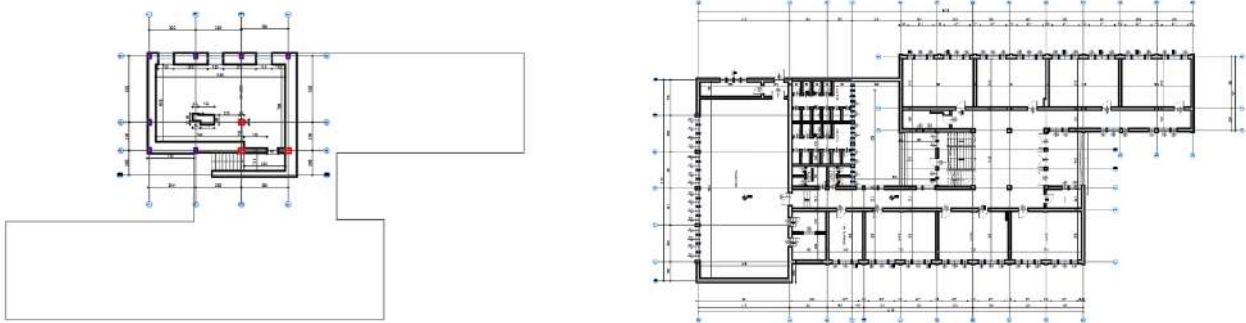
Planimetria e katit nëntokë dhe katit perdhe gjendja ekzistuese
